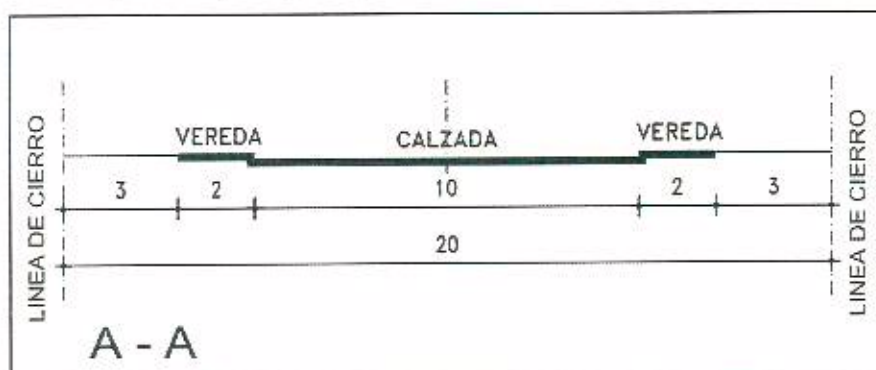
Esquema de construcción de extensión de Calle Cornisa.
